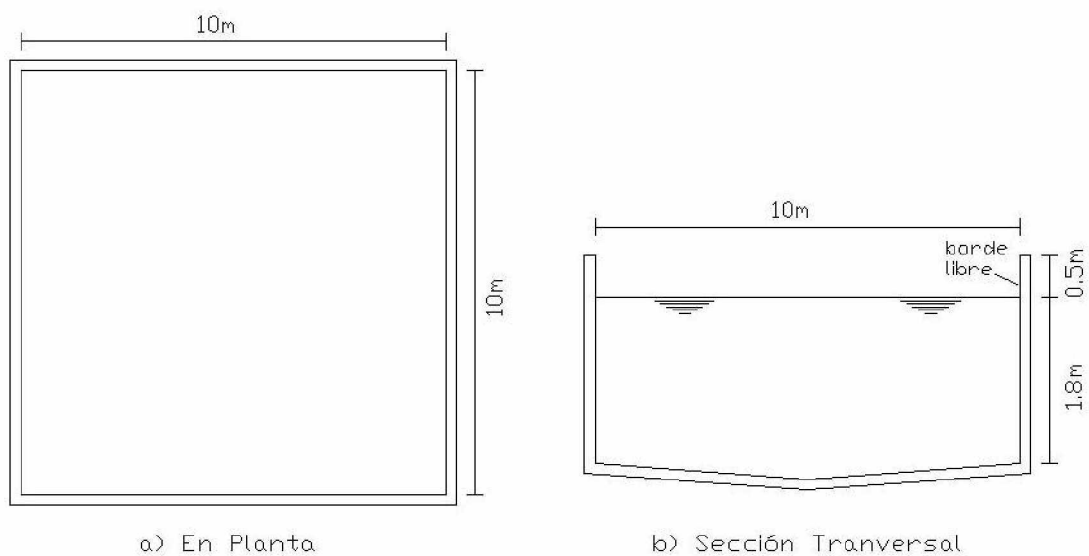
Esquemas del filtro percolador de la Planta N°2
